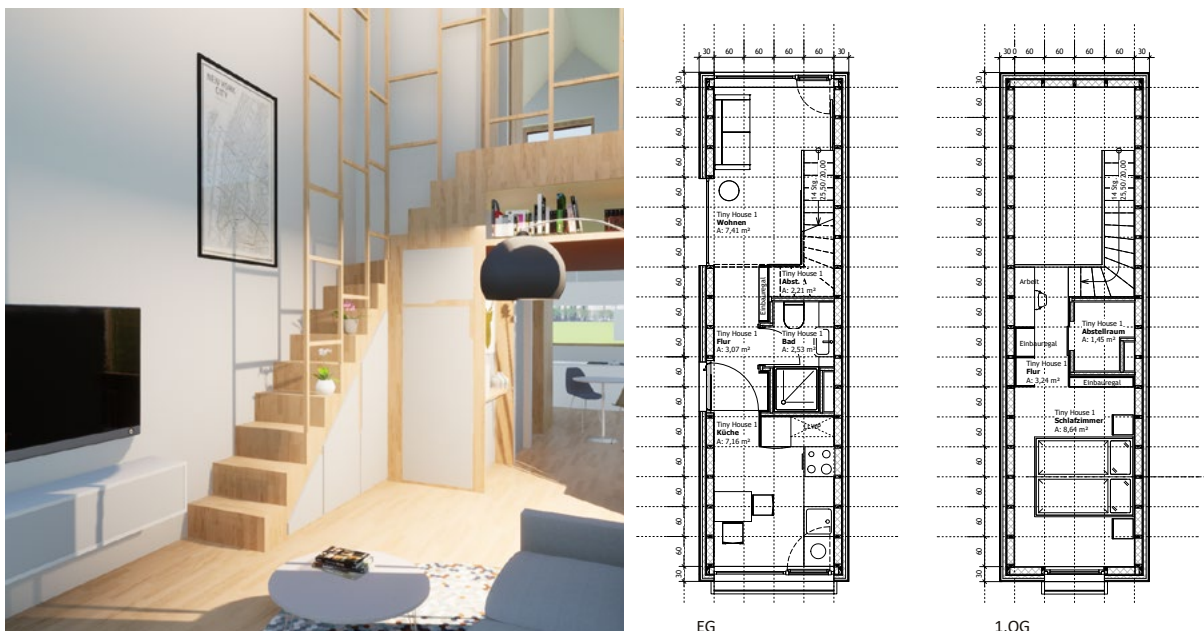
Beispiel eines Hauses mit 34m², bei dem der Schlafbereich im offenen Dachraum angesiedelt und damit optisch abgetrennt ist. Links: Innenansicht des Hauses. Rechts: Grundrisse von Erdgeschoss und oberer Etage. Grafik: Quinke Moritz Architekten, Beitrag im Wettbewerb Zukunftsstadt.
